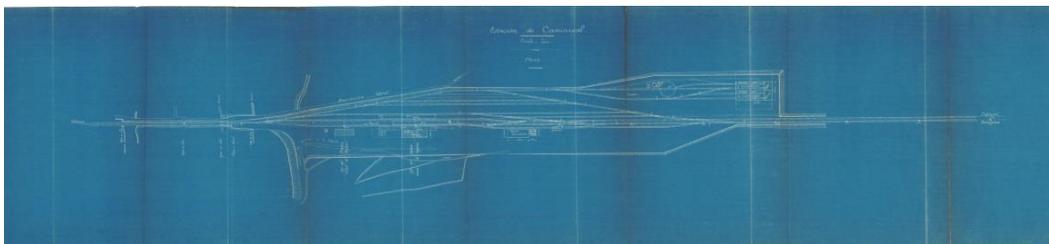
Plano de vías e implantación de la estación de Caminreal. Plano de proyecto. (Fuente: Archivo AHF, 1932)
